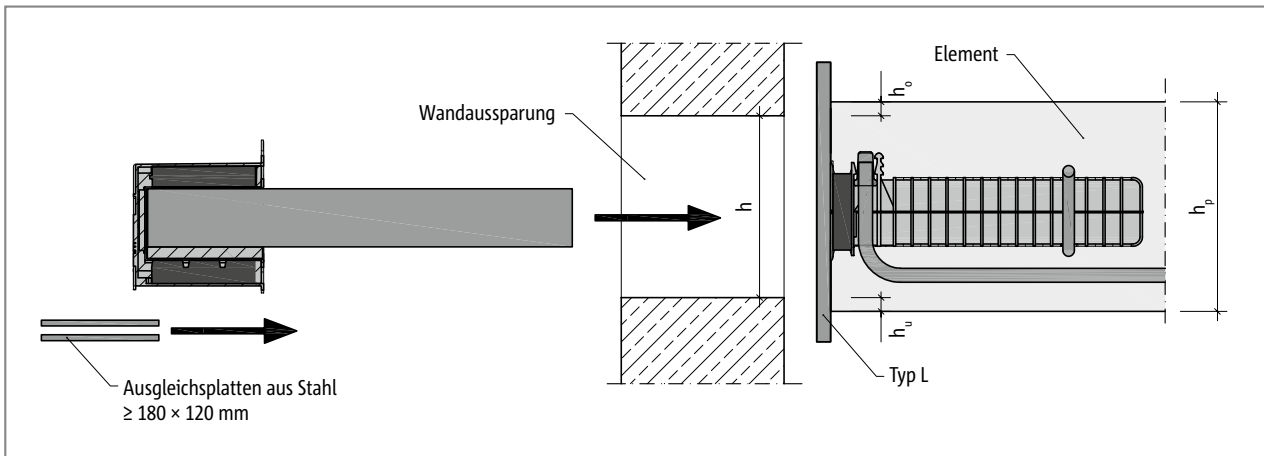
Schöck Tronsole® Typ P: Wandaussparung bei Elementbauweise
